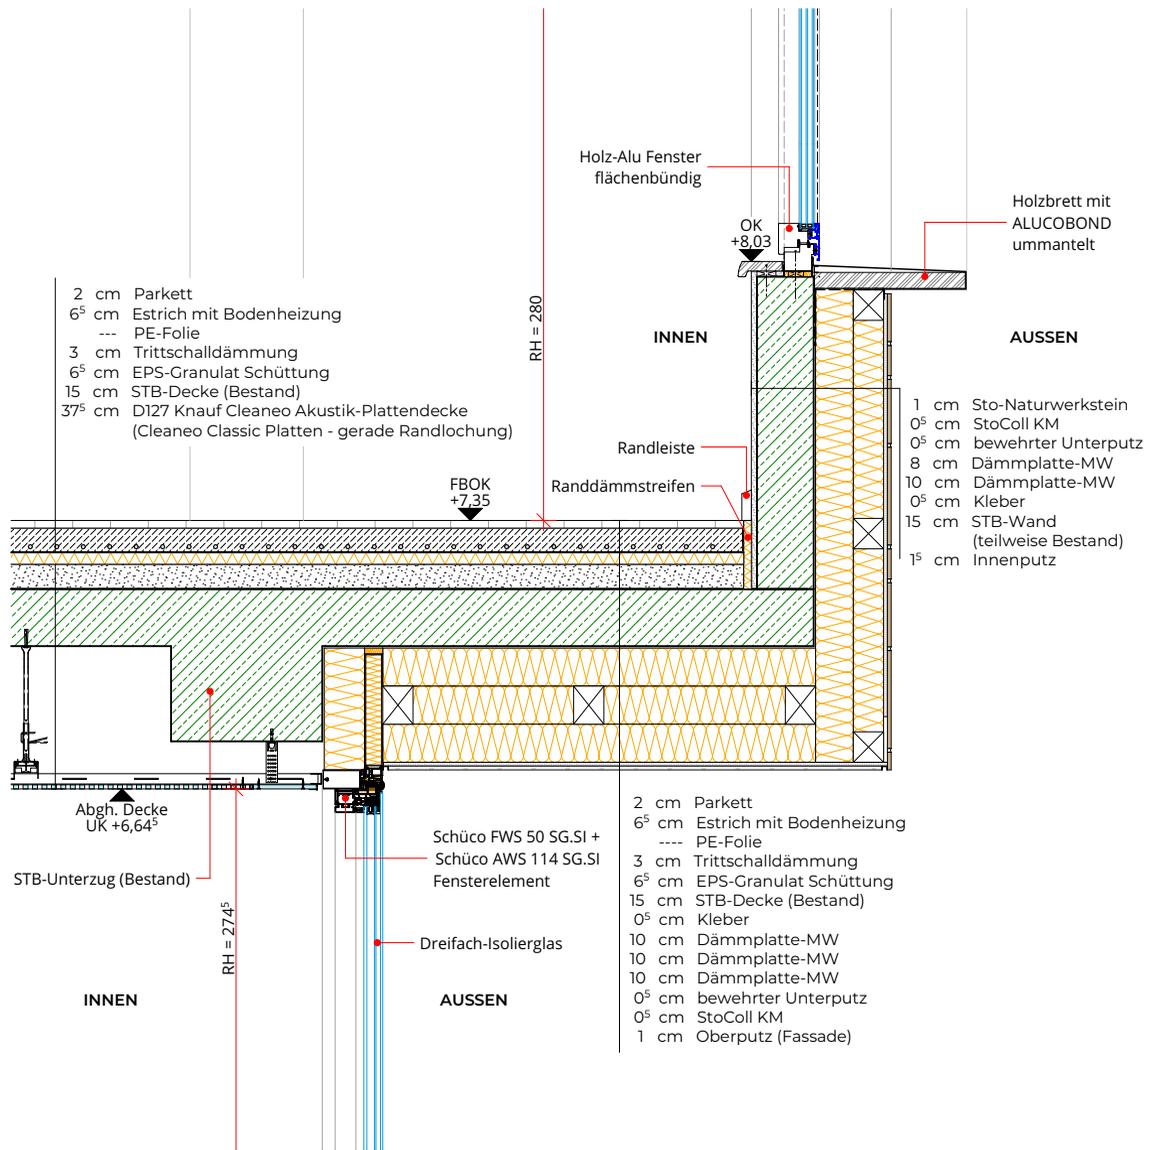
D04_Fassade und Zwischendecke 1.OG-2.OG mit Auskrägung und Fensteranschluss
